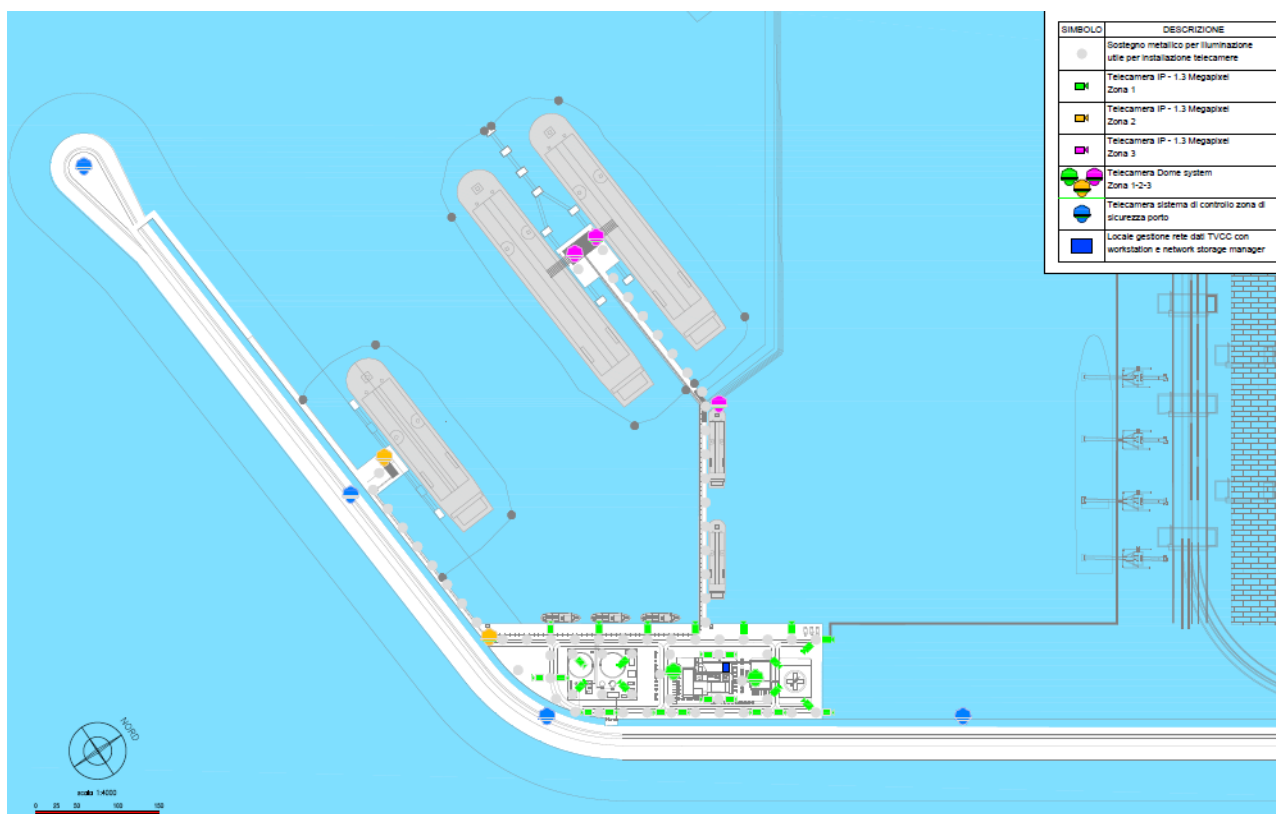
Particolare planimetria distribuzione impianto TV/CC sul terminal petrolifero
